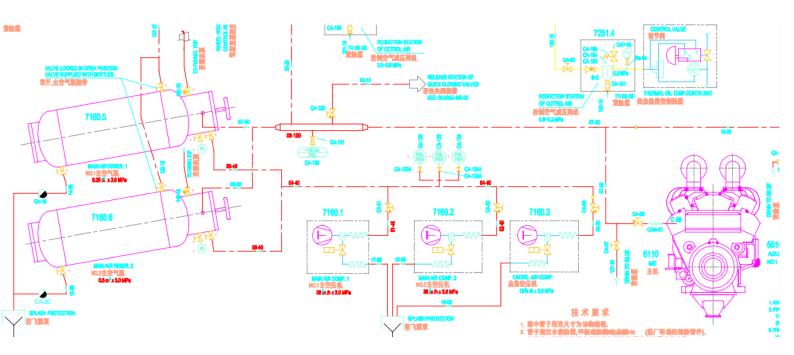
Plano en detalle del sistema de aire de arranque. Fuente: Planos de la sala de máquinas.
